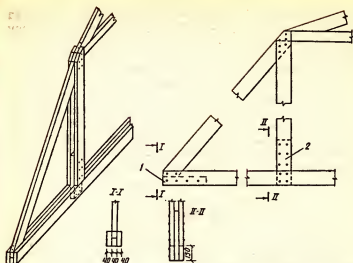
Конструкция стропильной системы с двухветвевой стойкой:
